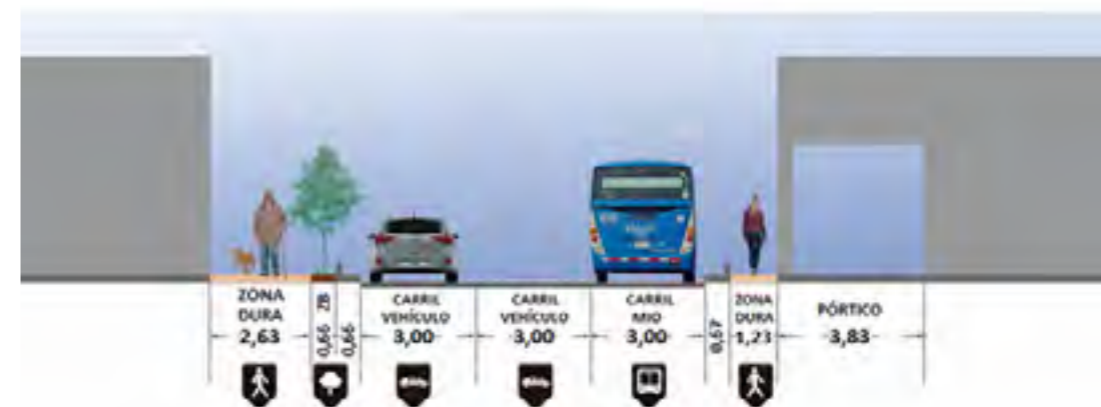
Perfil vial de la Avenida Sexta Norte entre Calles 12AN y 13N.
